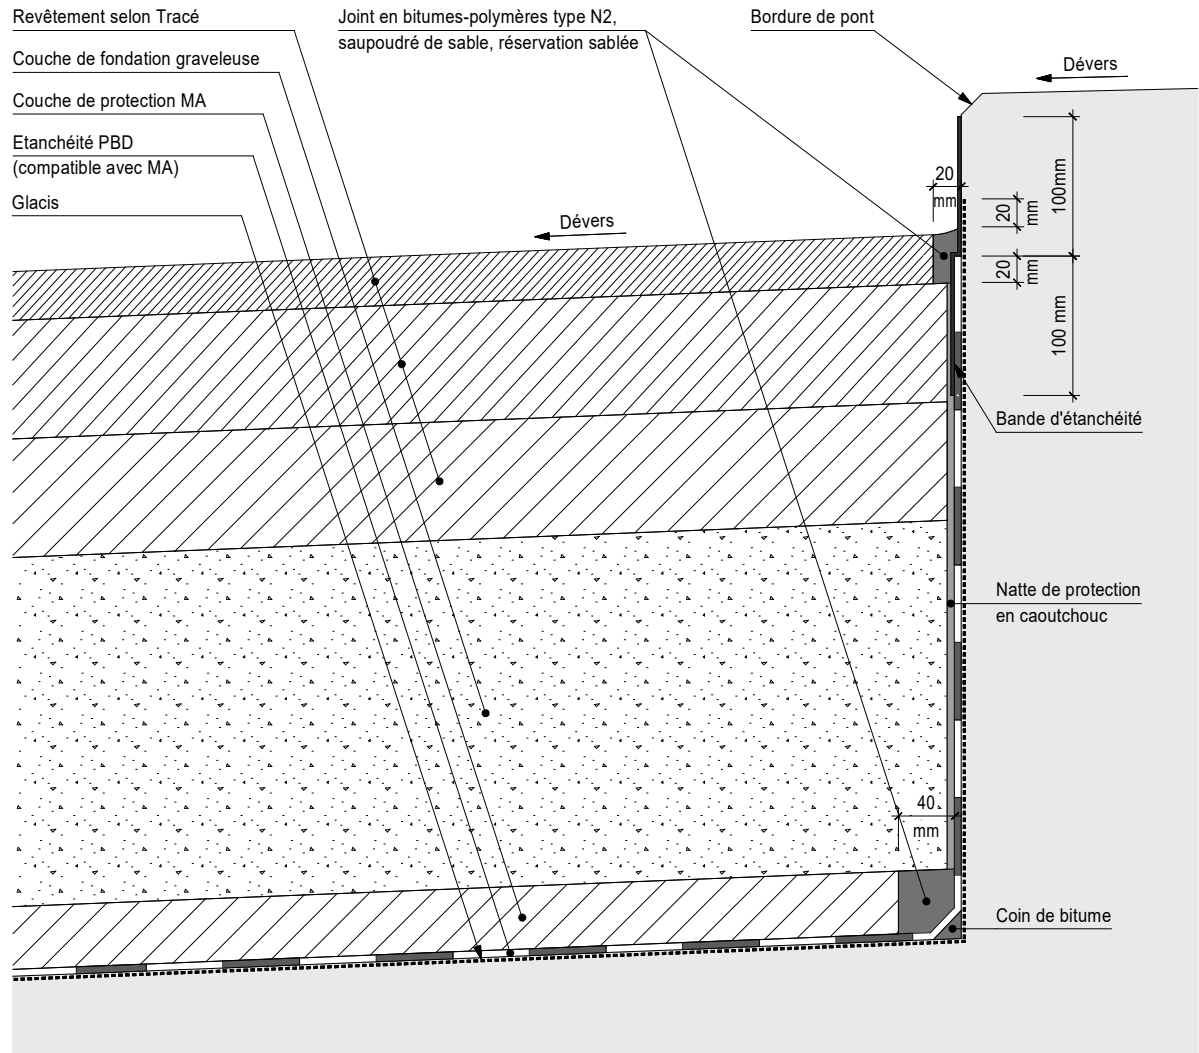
Système d'étanchéité PBD - Pont avec fondation graveleuse- Point haut
